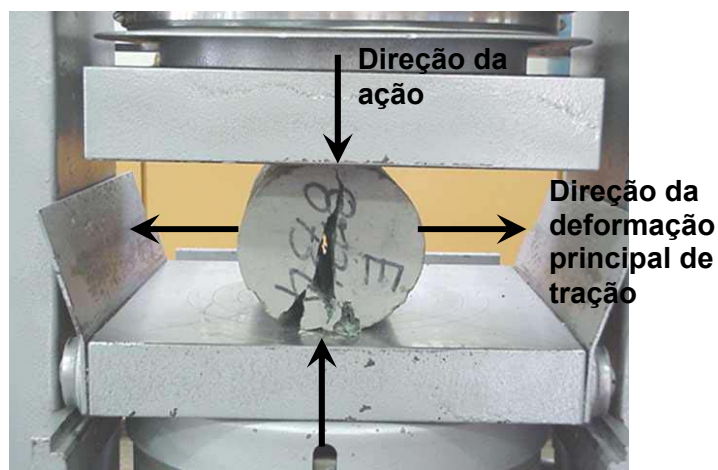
Fissuras provocadas por esforços de tração. Ensaio de tração por compressão diametral
